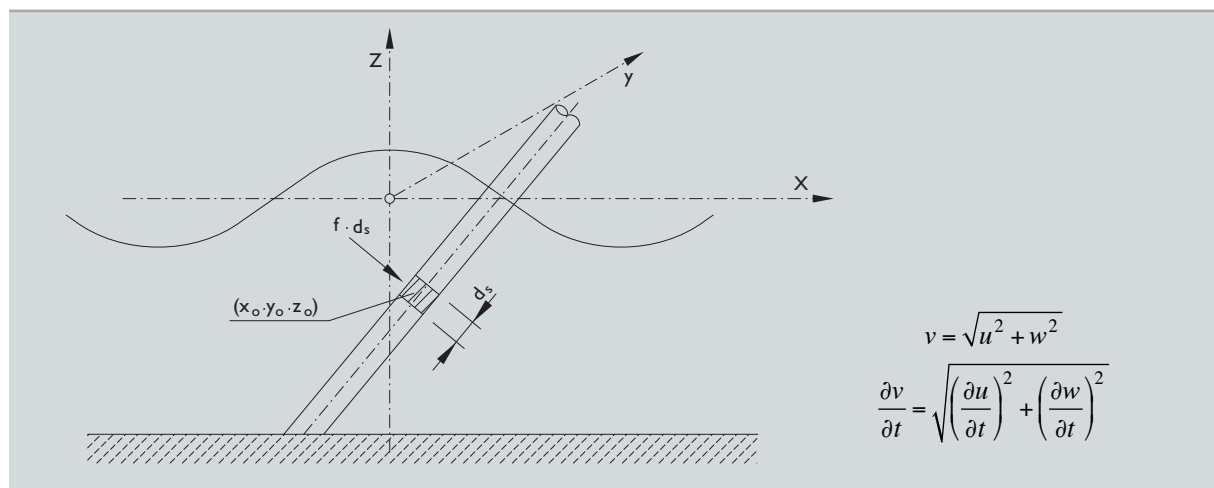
Acciones del oleaje sobre un pilote (o pila) aislado inclinado
